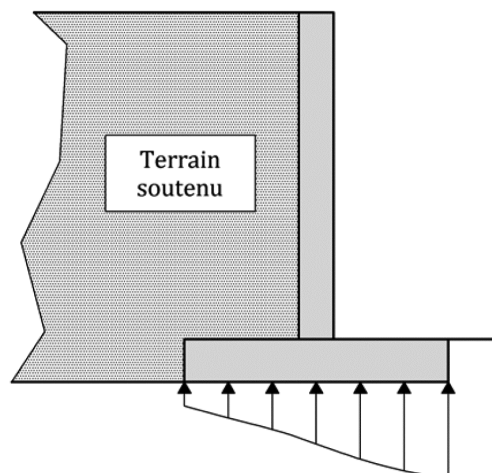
Exemple de contraintes à la base d'un mur en béton armé en forme de T renversé
